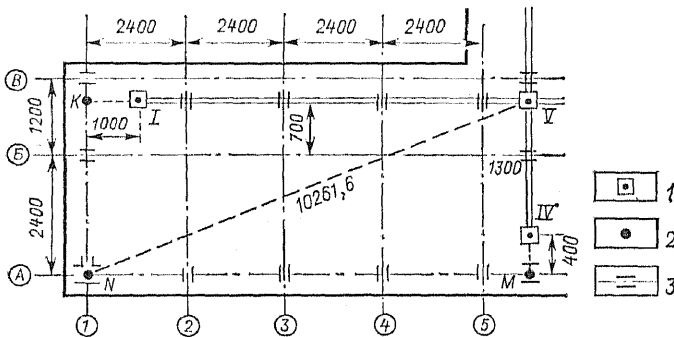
Схема детальной разбивки осей на монтажном горизонте: 1 — пункты разбивочной сети; 2 — точки разбивки осей; 3 — откраски осей на перекрытиях монтажного горизонта
